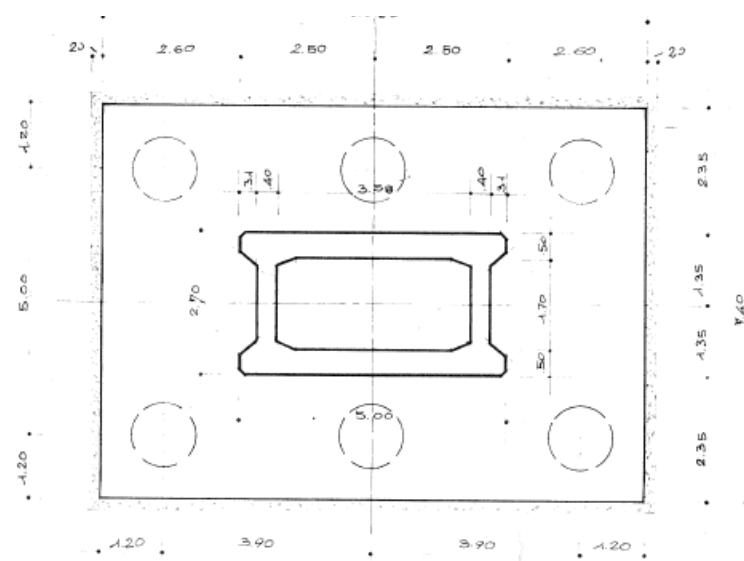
Pianta della fondazione con indicazione dei pali, 6 pali
